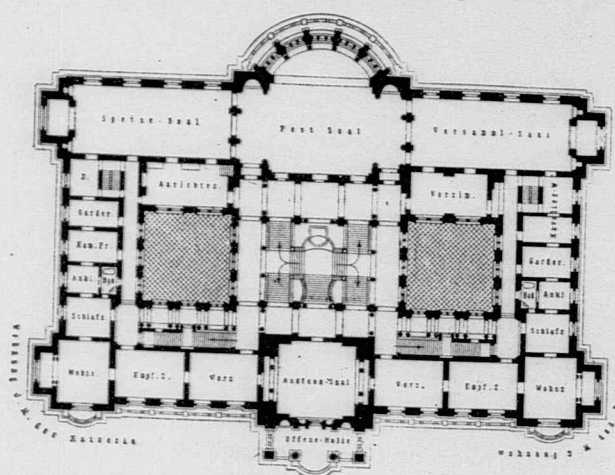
Grundriß des Kaiserpalastes in Straßburg. Arch.: H. EGGERT.
